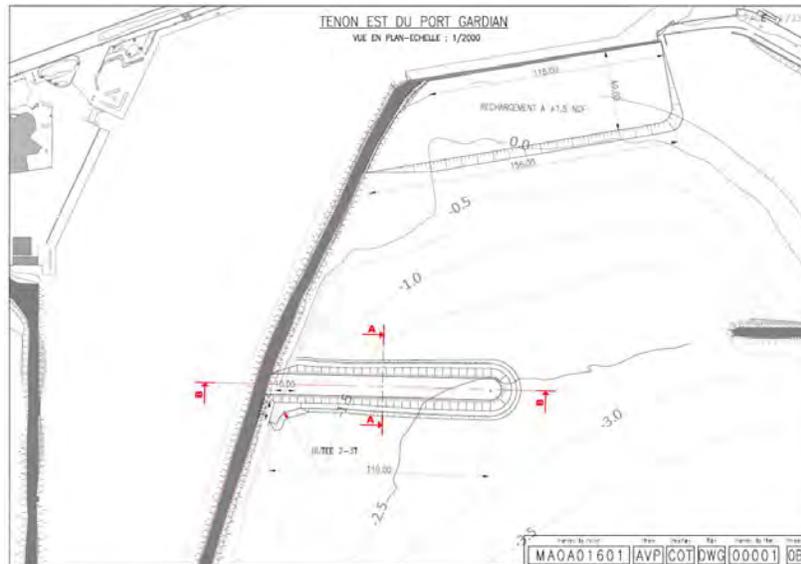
vue en plan de l'aménagement « création d'un tenon de protection de Port Gardian »
